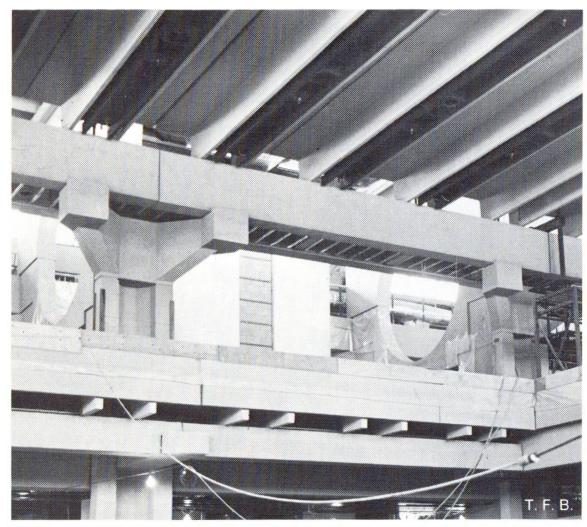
Intérieur de la halle pendant le montage. On remarque le mode de support de la poutre longitudinale sur laquelle s'appuient les poutres en T de 21 m de portée de la toiture de la halle latérale.
